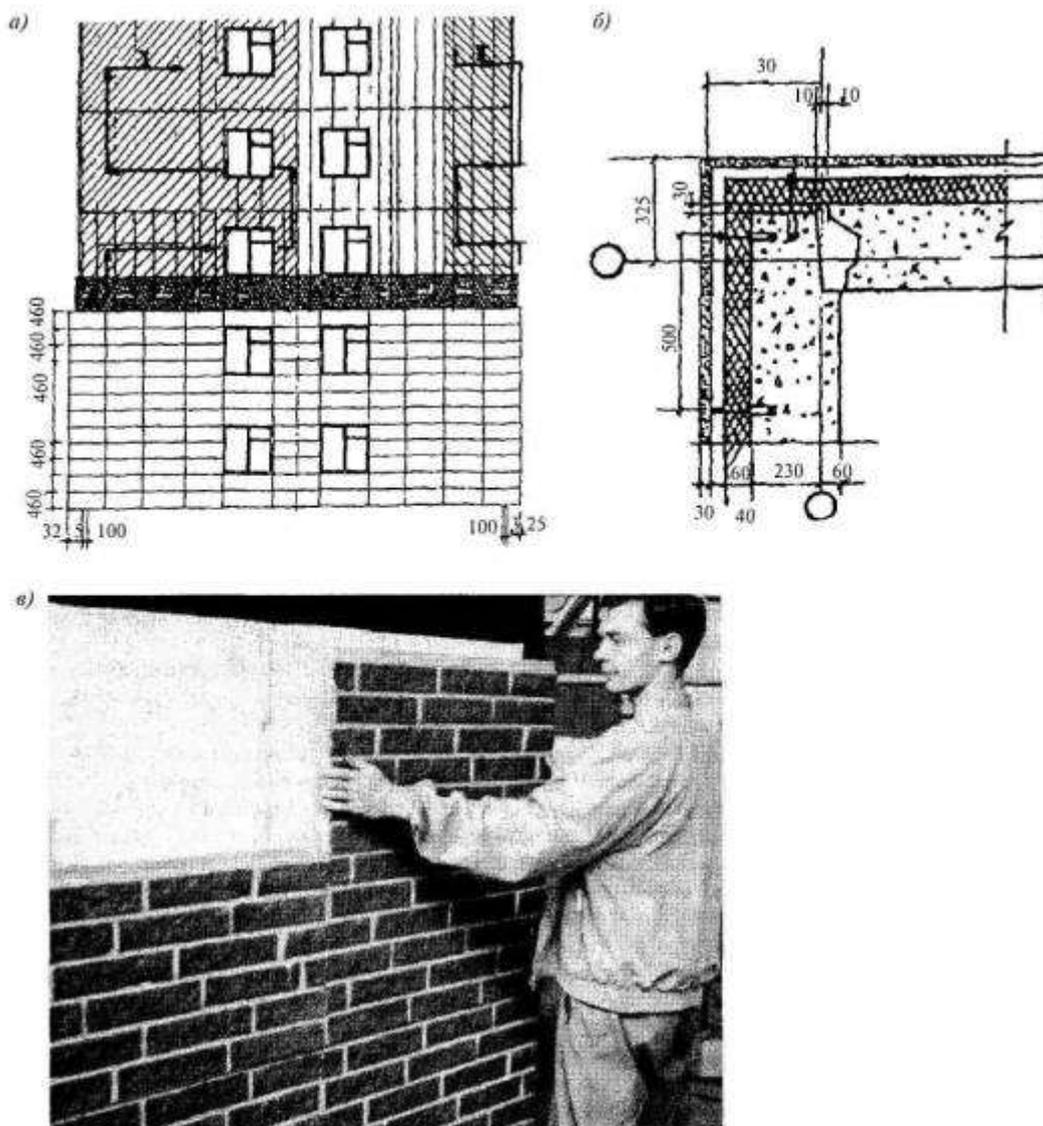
Технологическая схема производства работ по устройству вентилируемого фасада (а), узел крепления угловых элементов (б) и рабочий момент установки панелей «под кирпич» (в)
